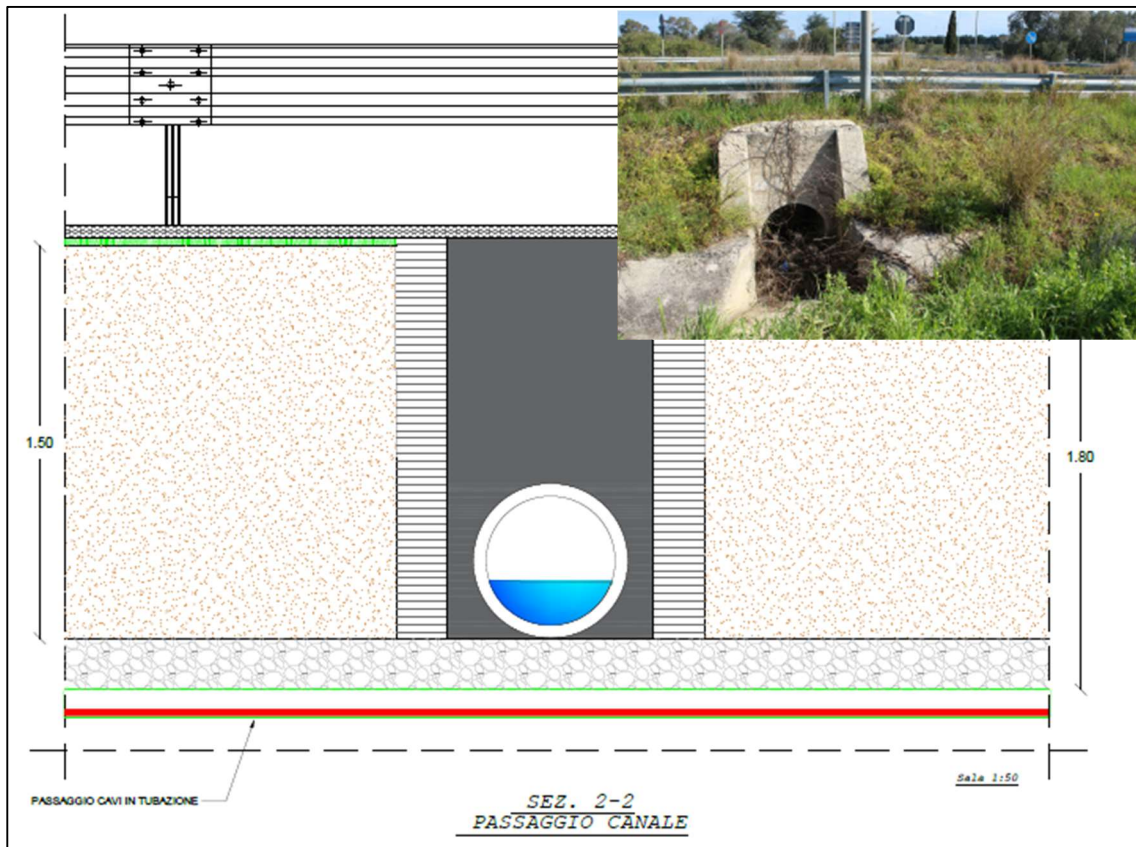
Particolare tecnico della sezione di attraversamento.
